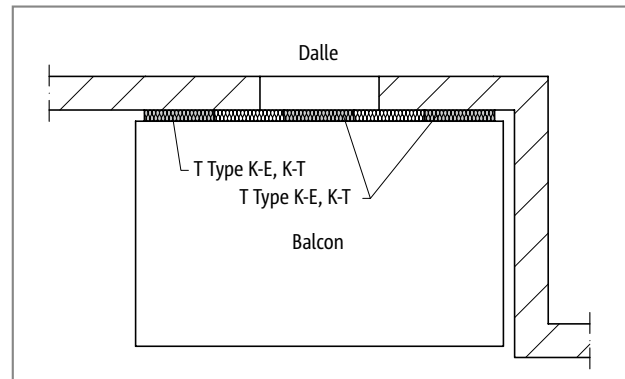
Schöck Isokorb® T Type K-E, K-T : Balcon avec décrochement de façade
